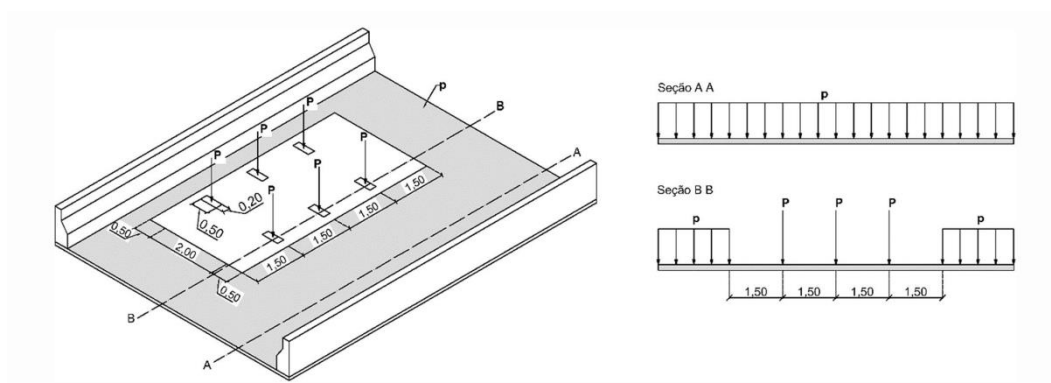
Disposição das cargas estáticas (NBR7188/2024)
